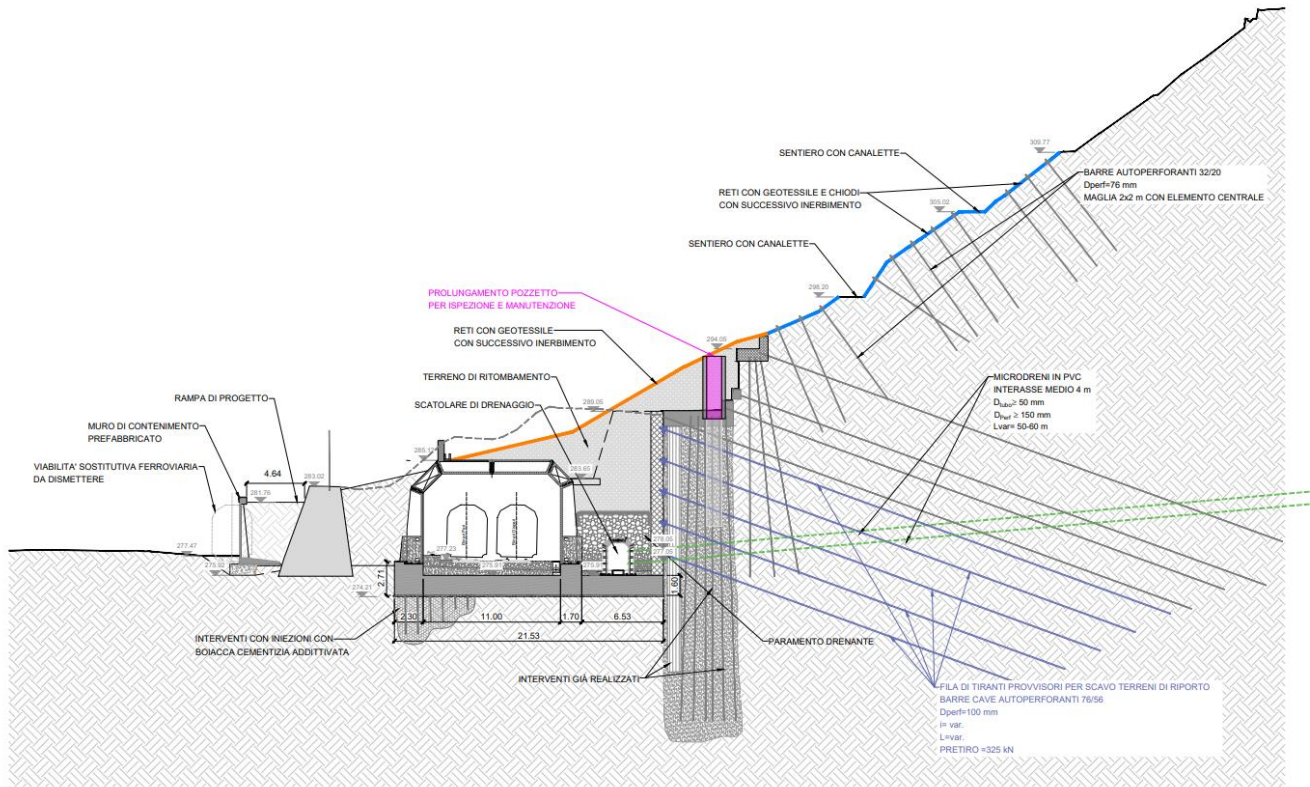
Stralcio di una sezione di intervento sul muro crollato consolidato.
